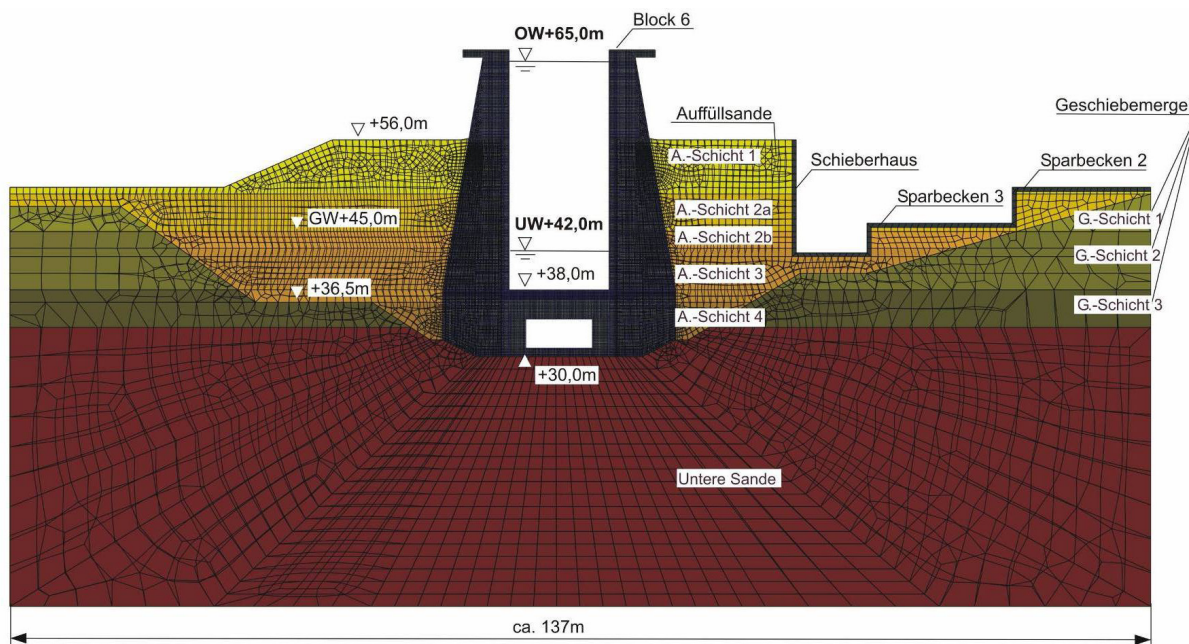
Gesamtmodell der Schleusenammer mit Baugrund und Nebengebäuden in einem repräsentativen Schnitt; zwischen Baugrund und Betonstruktur wurde eine Kontaktfläche definiert
